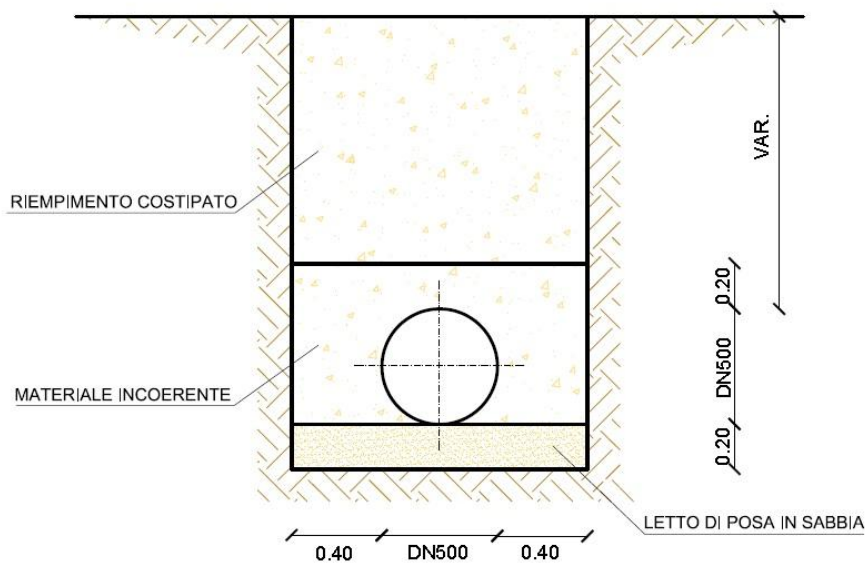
Stazione di sollevamento ‘Passo della Sentinella’: fossa di posa della condotta di scarico.
